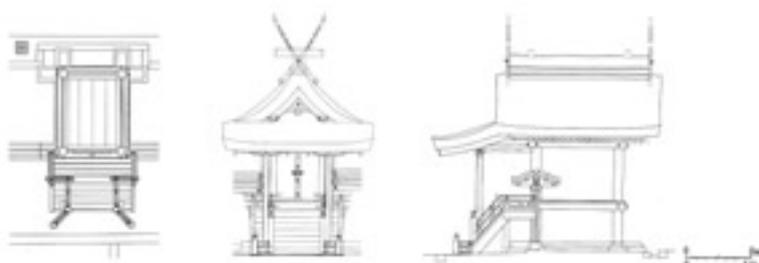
春日大社本殿 平面図 正面図 側面図 『日本建築史図集』（日本建築学会編）
